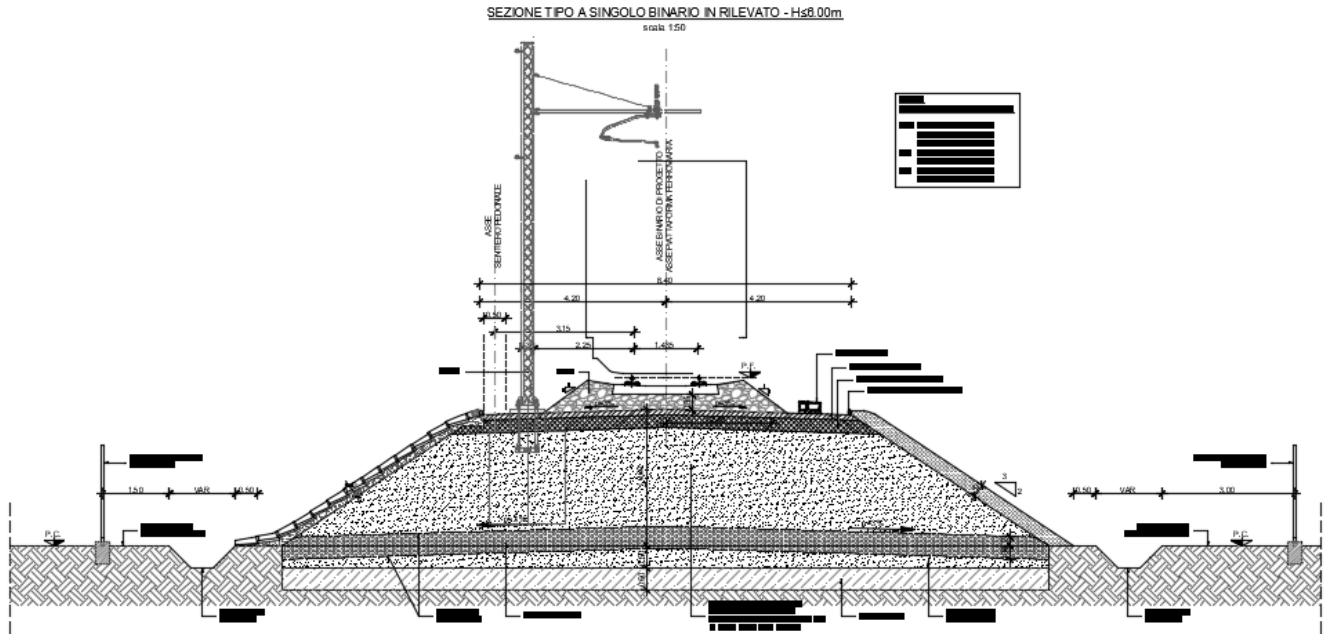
Sezione tipo SB in rilevato - asta L=750m
